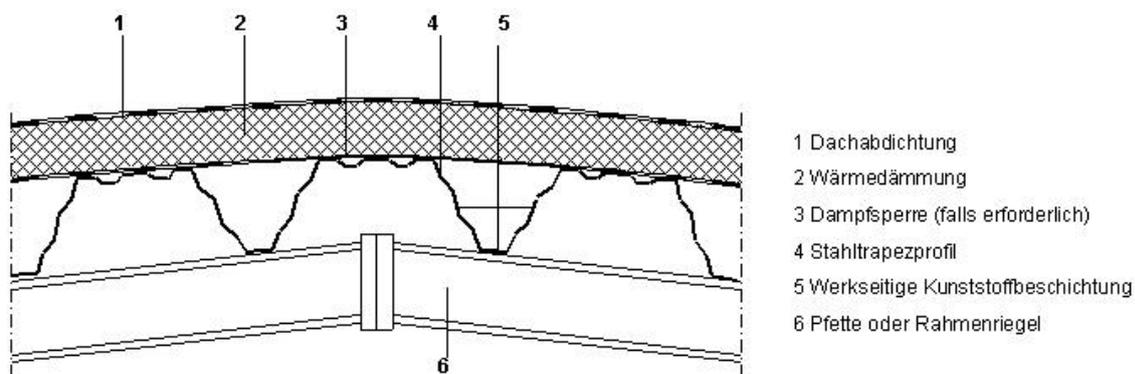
Aufbau eines Warmdaches unter Verwendung von Stahltrapezprofilen
